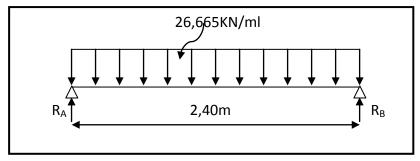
Schéma statique de la poutre palière à l'ELS.
